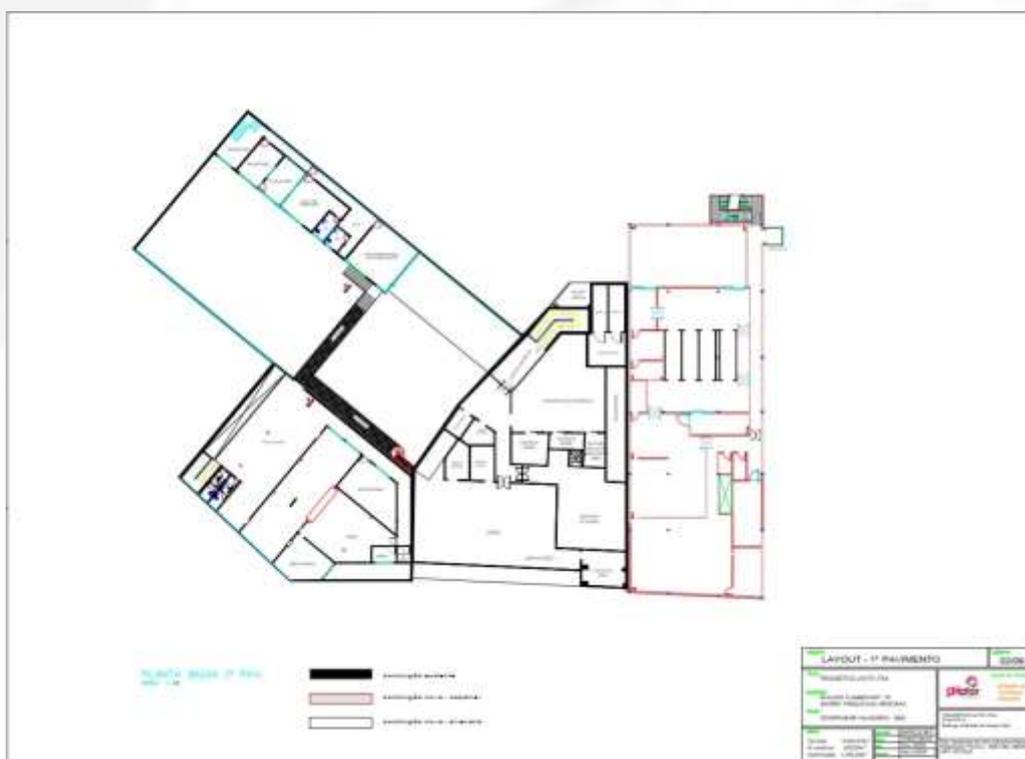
Planta Baixa / Layout do 1º pavimento – Frigorífico Leste Ltda.
